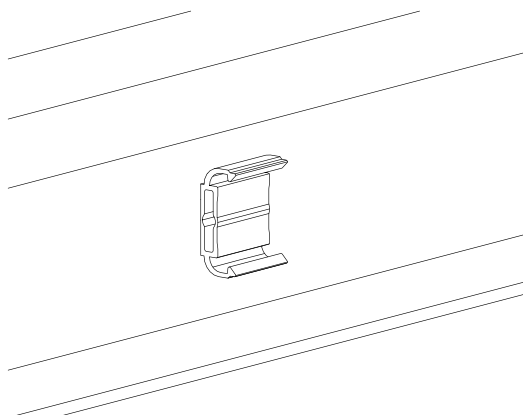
Schienenhalter ist in der kundenseitigen Haltekonstruktion/Unterkonstruktion montiert
